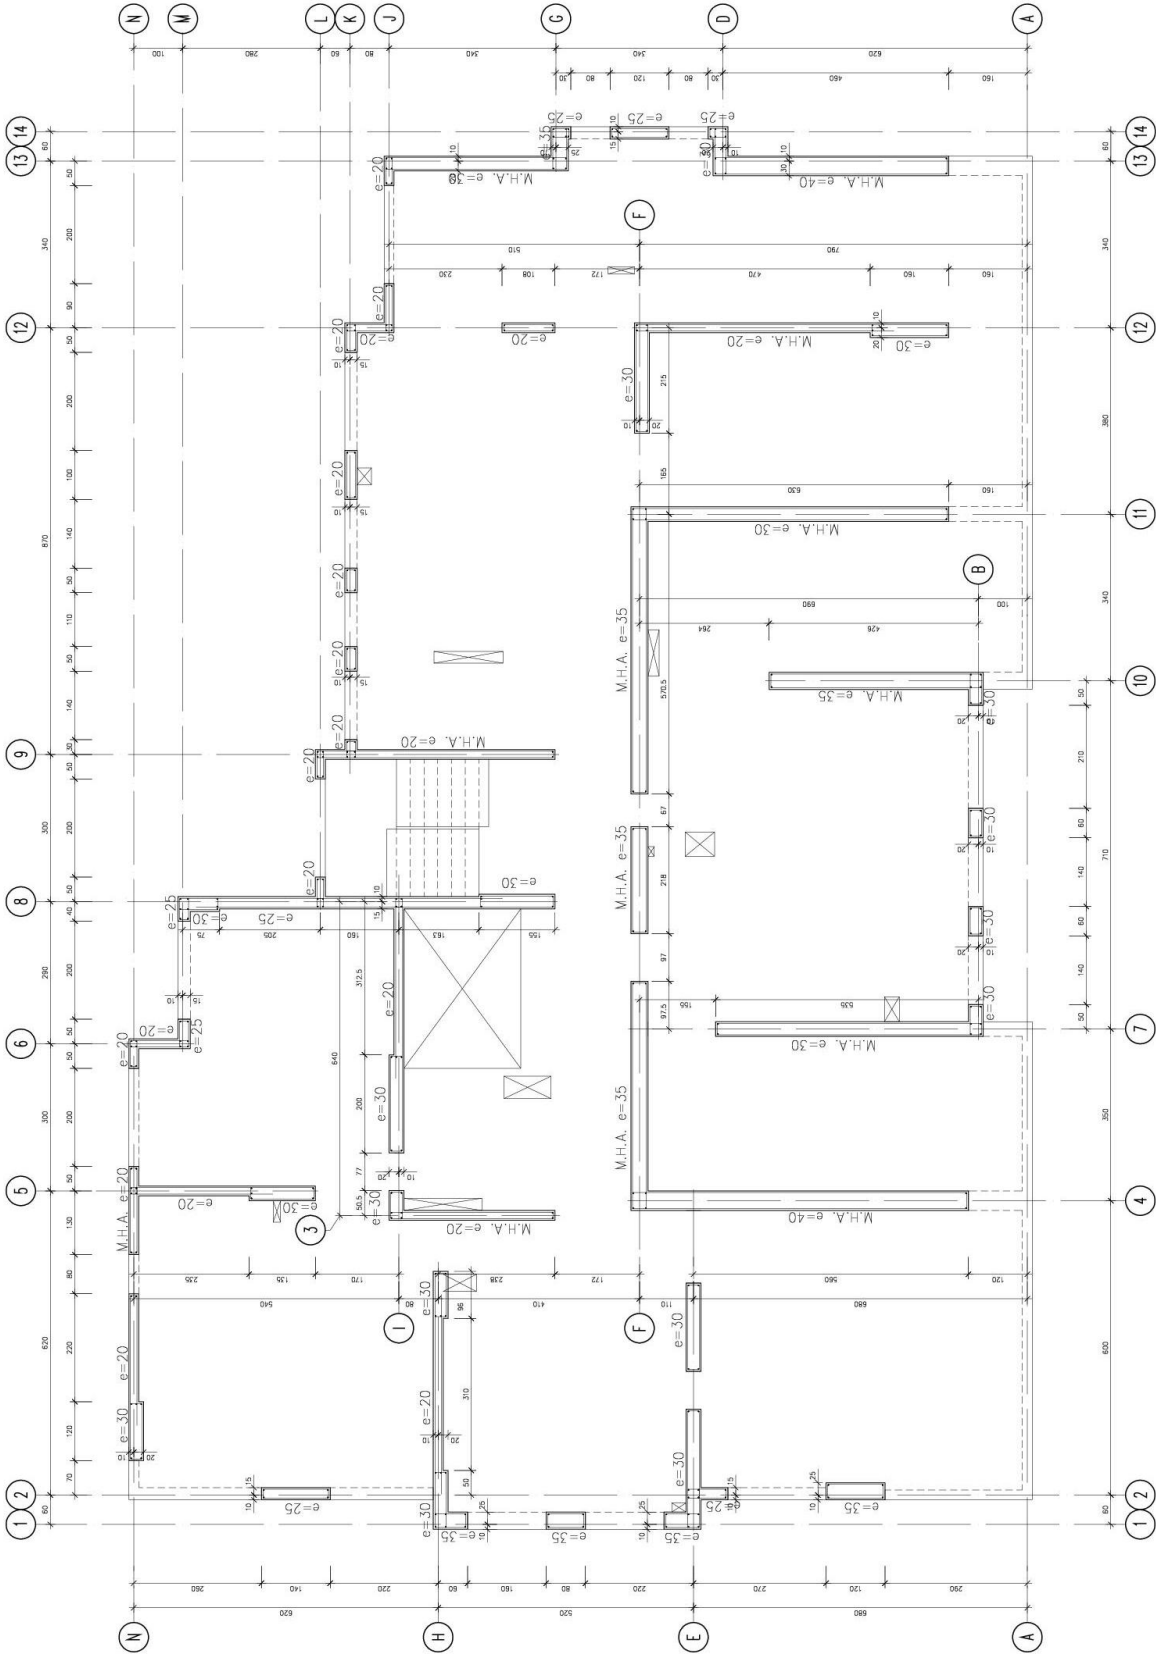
Planta de estructura cielo 2° piso a 3° piso
